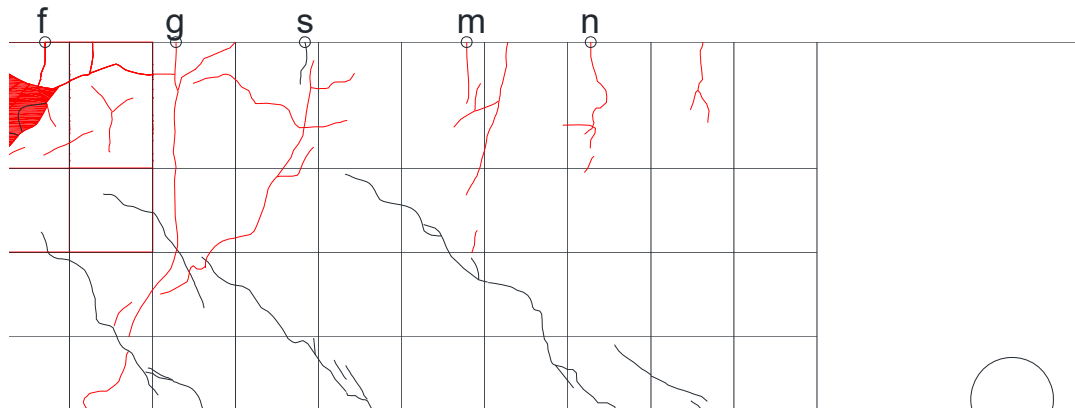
基礎梁ひび割れ測定位置(試験体 E-1 負荷荷)
